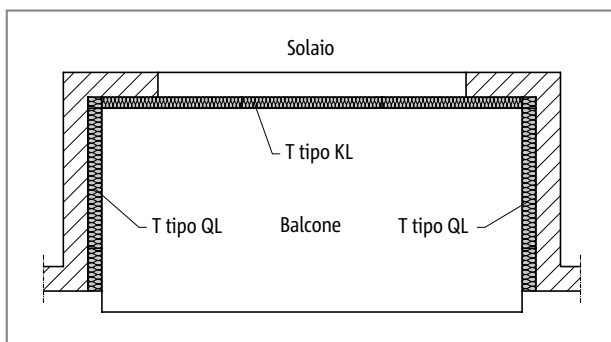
Schöck Isokorb® T tipo KL e tipo QL: balcone appoggiato su tre lati
